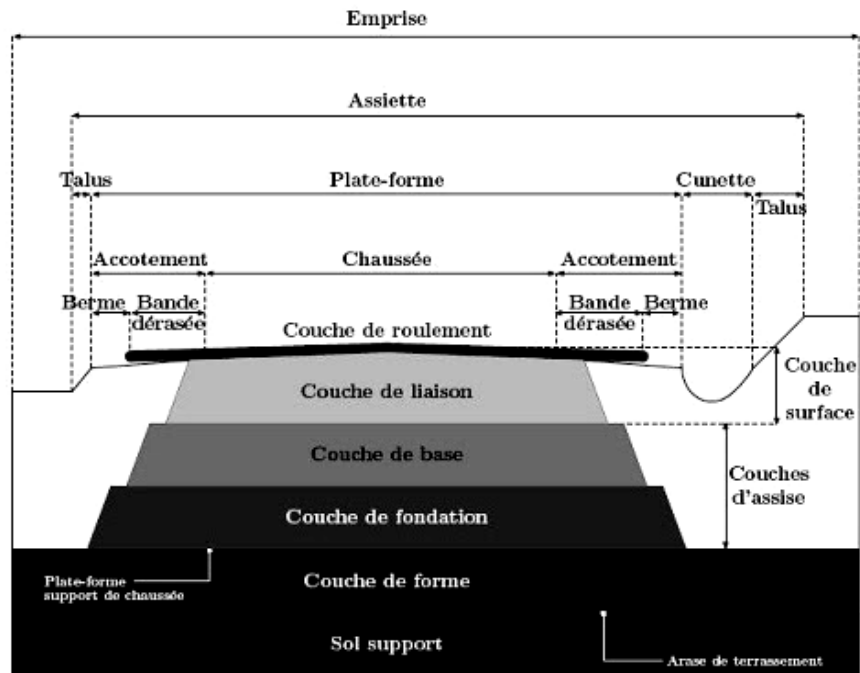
Coupe transversale d'une chaussée. [EHG, 2010]
